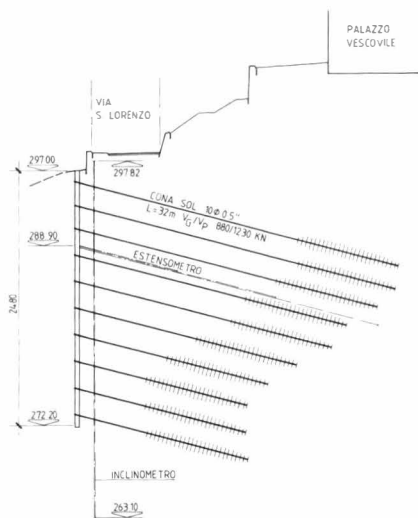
Schnitt durch Elementwand – Coupe en travers – Sezione verticale
